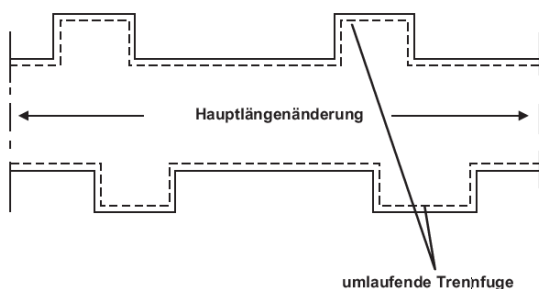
Ausführung mit umlaufendem gleitendem Anschluss
